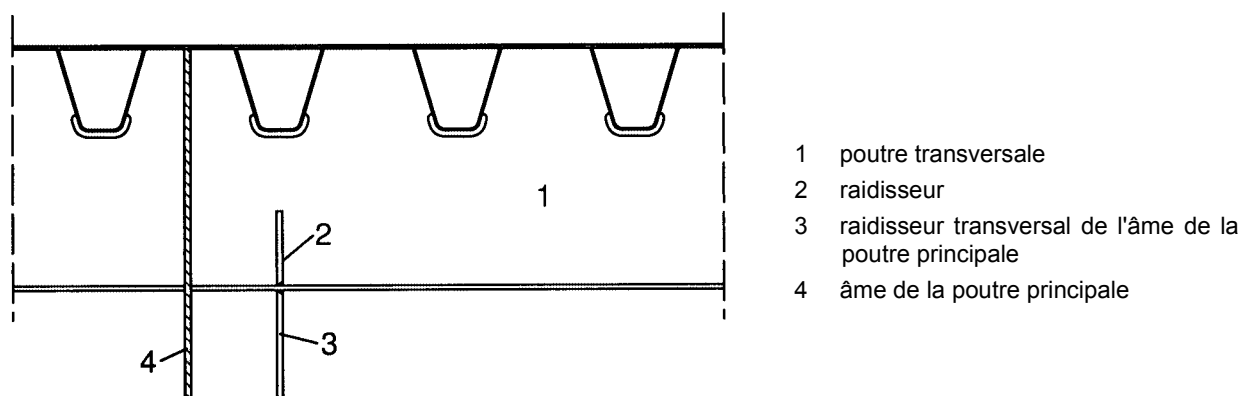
Assemblage type de la poutre transversale et du raidisseur transversal de l'âme de la poutre principale
